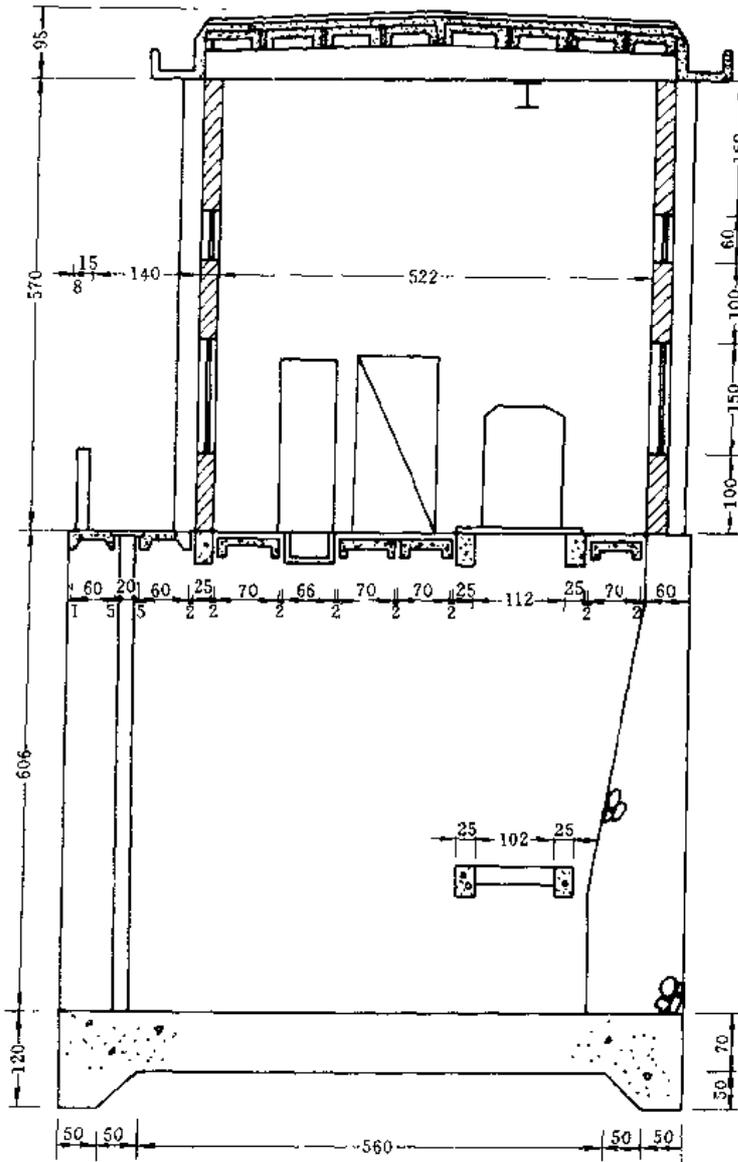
泵房纵剖视尺寸图 (单位: cm)
